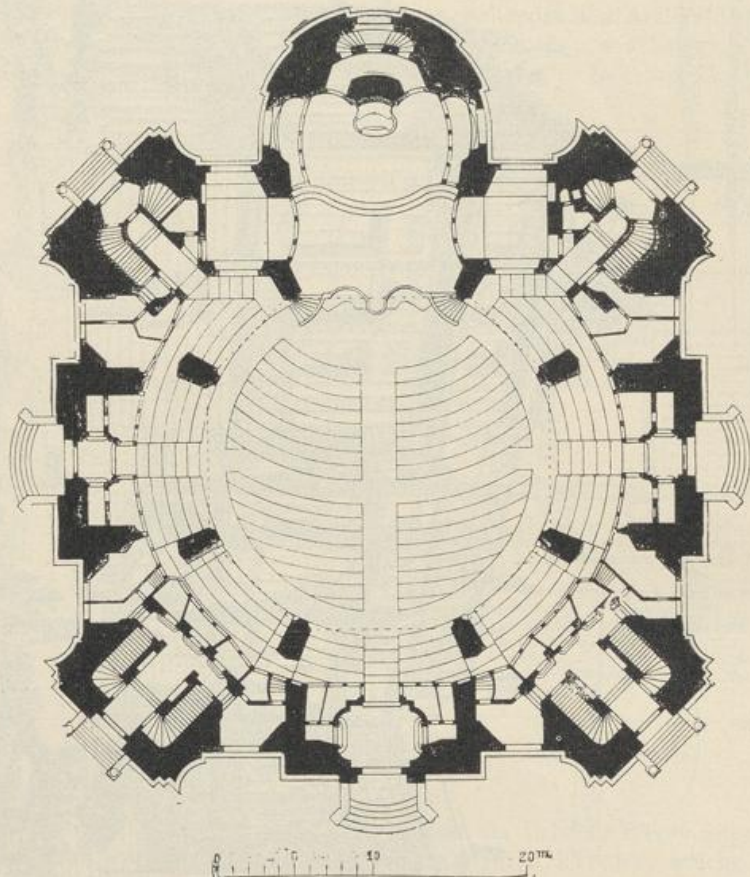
Grundriss der Frauenkirche in Dresden
